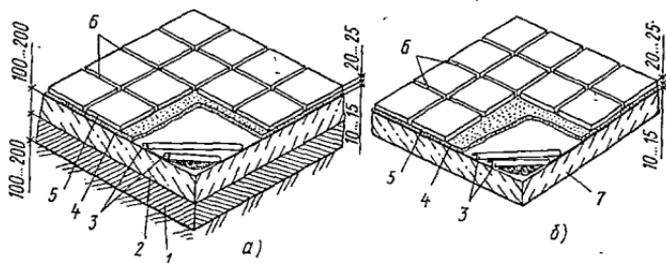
Кислотостойкие полы, уложенные на грунте (а) и на междуэтажном перекрытии (б):
